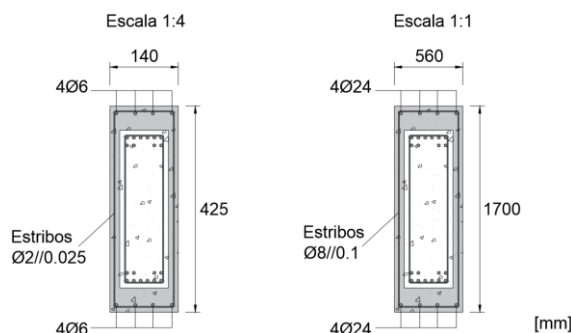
Secções transversais da viga central com reforço por encamisamento de betão e armaduras para o pórtico à escala 1:4 e 1:1
